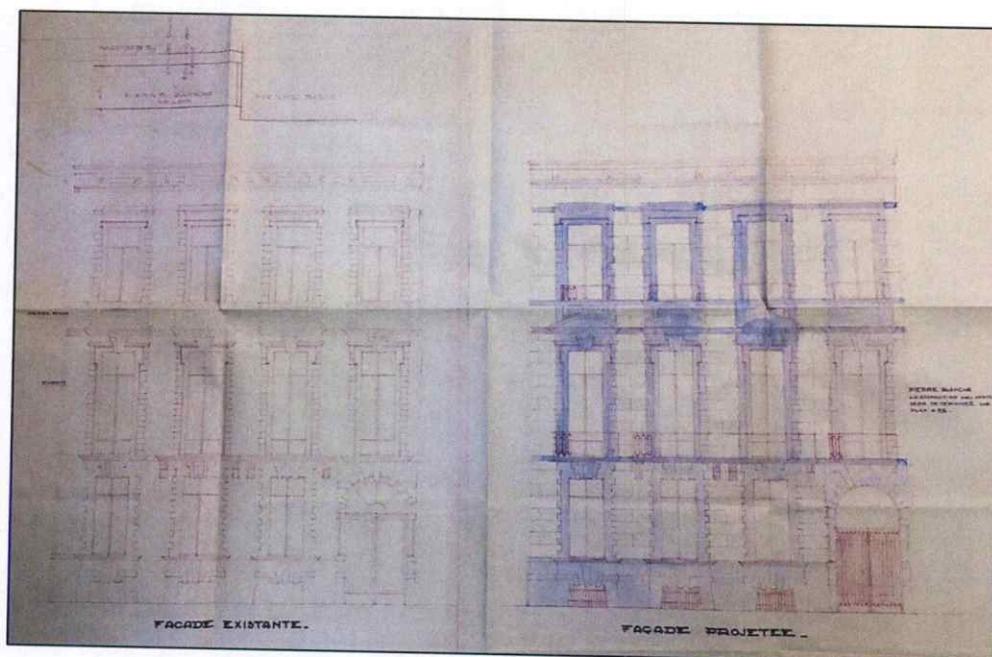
Extrait de la demande de 1954 : décapage façade et placement pierre blanche de Lens (source Archives de la ville de Bruxelles)
